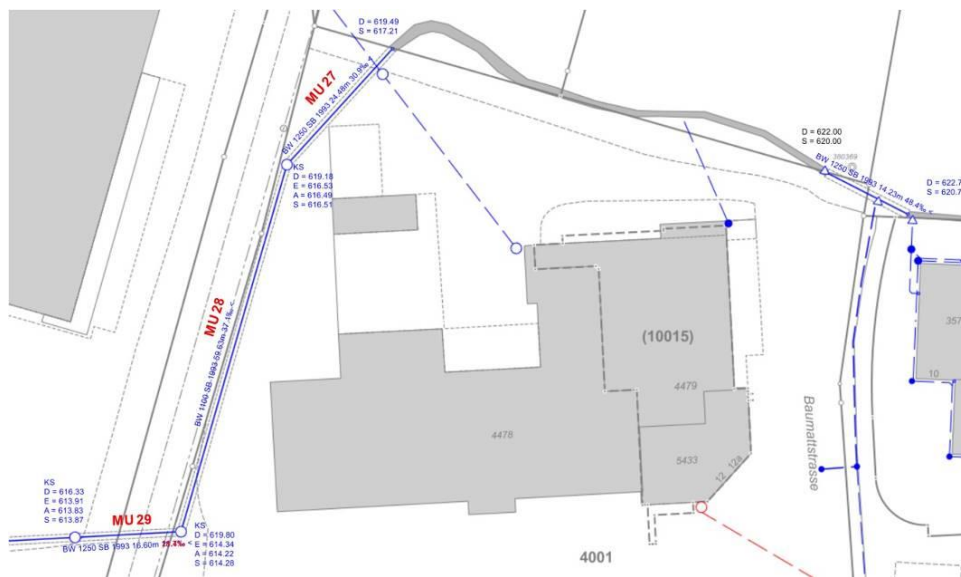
; Ausschnitt aus Plan Haltungen GEP (Genereller Entwässerungsplan) Berechnung (ohne Massstab)
